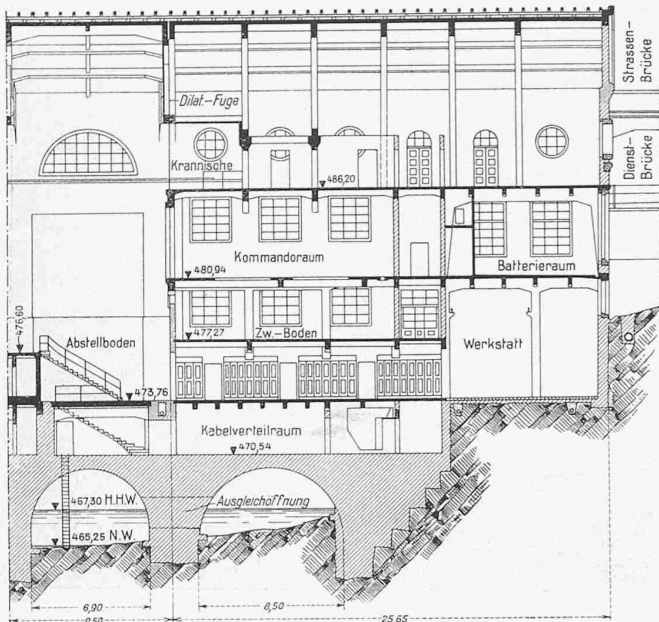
Längsschnitt durch den Maschinenhausanbau. — 1:400.
